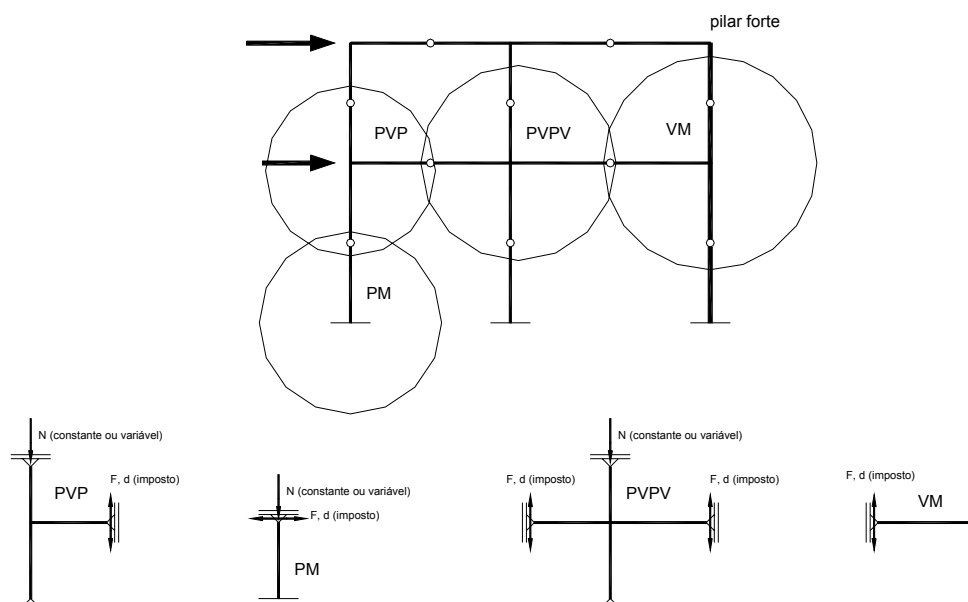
Estratégia de sub-estruturação e configurações de ensaio.
